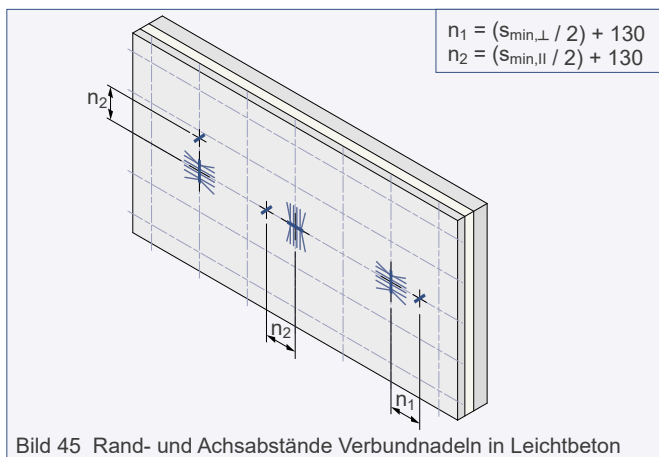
Rand- und Achsabstände Verbundnadeln in Leichtbeton
